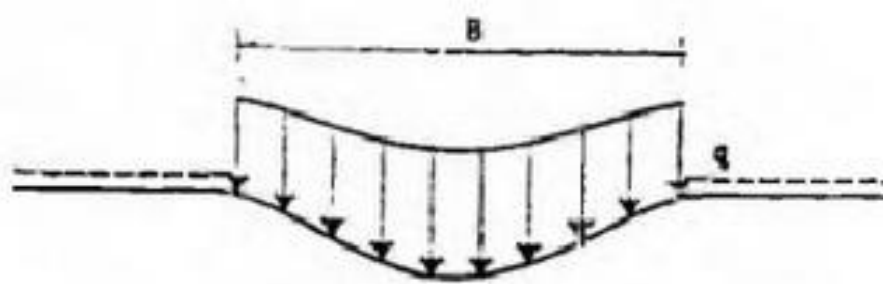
Perfil de asentamiento bajo un área uniformemente cargada sobre arcillas saturadas.
